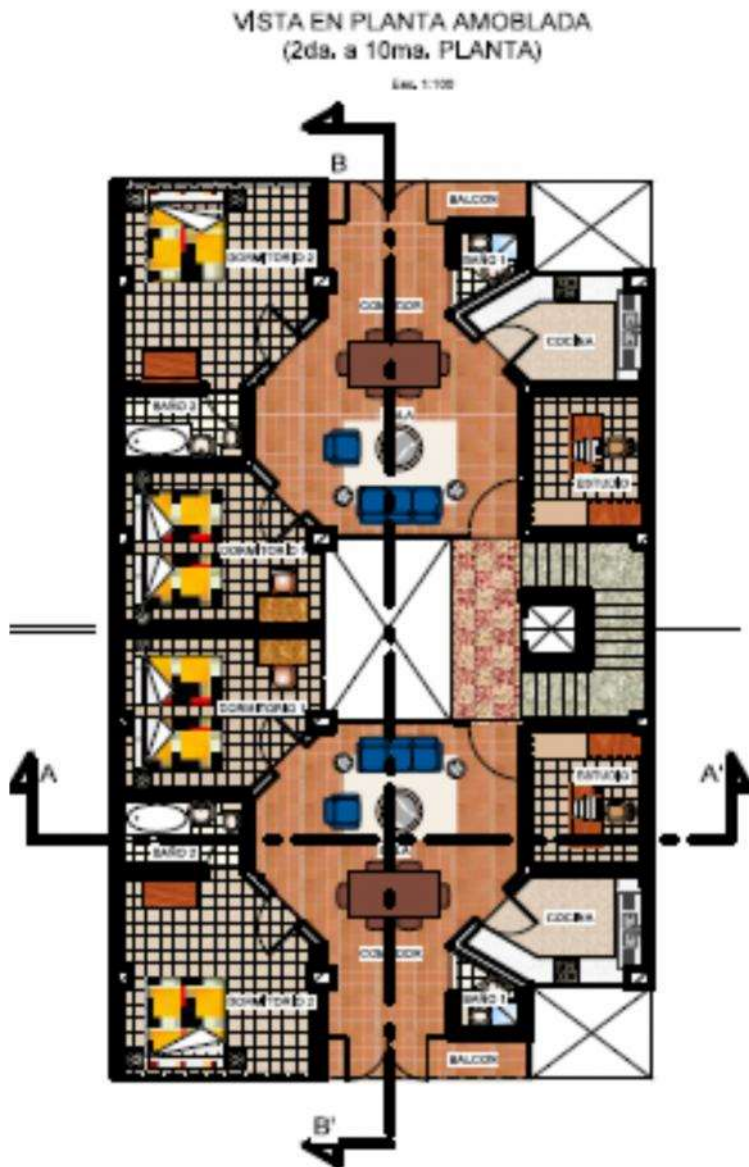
(Vista en planta del edificio objeto del estudio – plantas 2 - 10)
